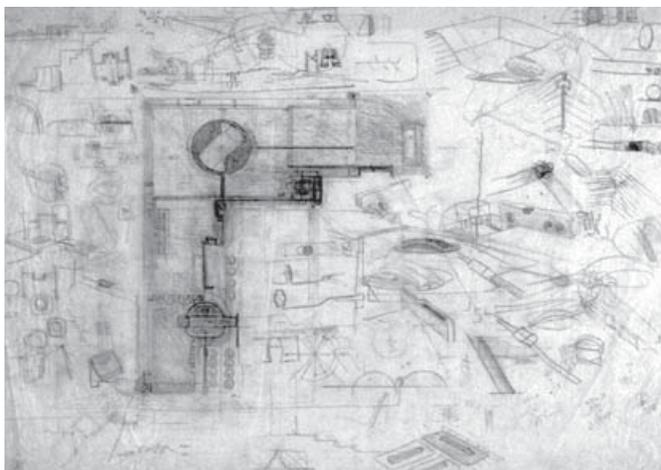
Camposanto Brion. San Vito d'Altivole. Planimetría general. Escala 1/250. Penúltima propuesta. 1969 (MAXXI)
